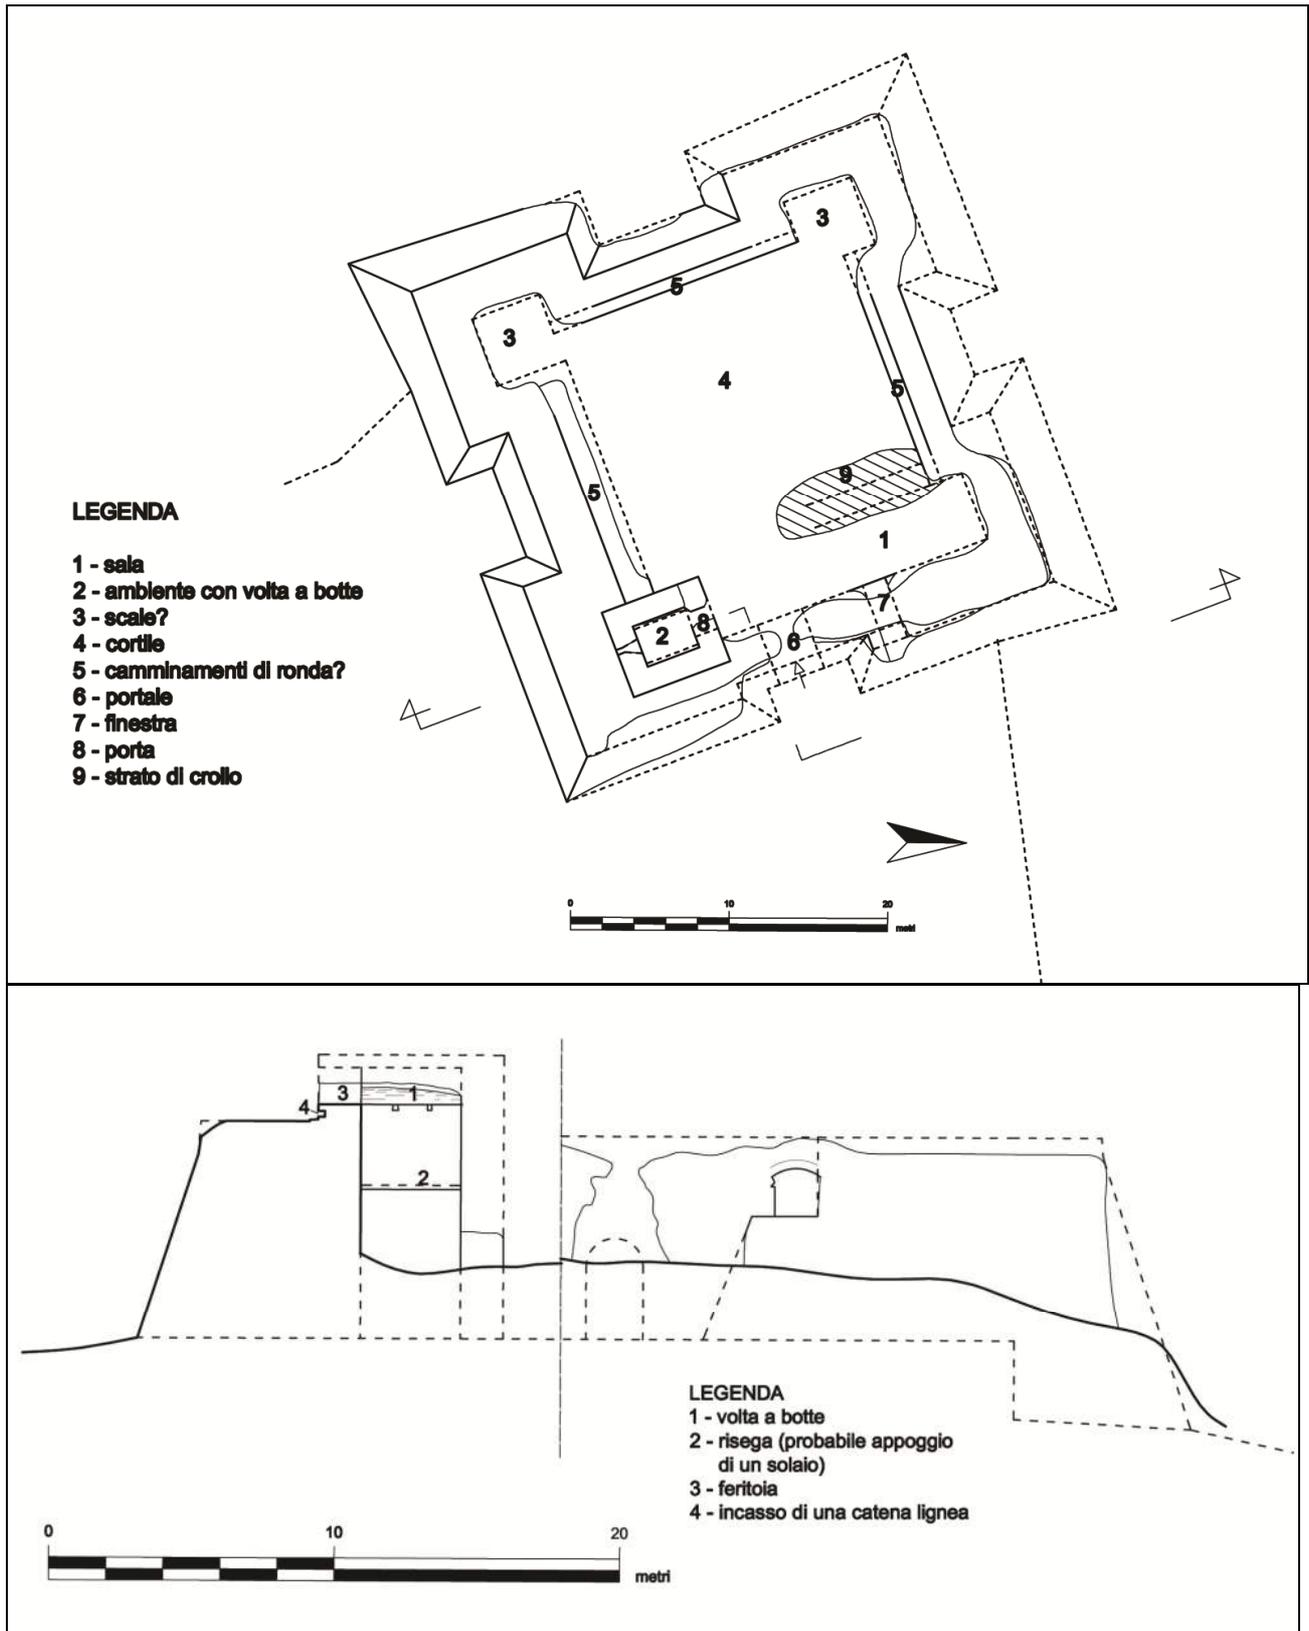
Castello di Tagliacozzo. In alto: pianta. In basso: sezione-prospetto, vista da E: a sinistra sezione dell'interno della torre SE; a destra prospetto della parete esterna meridionale. Ipotesi ricostruttive a tratteggio (rilievo di M. Bianchini)
